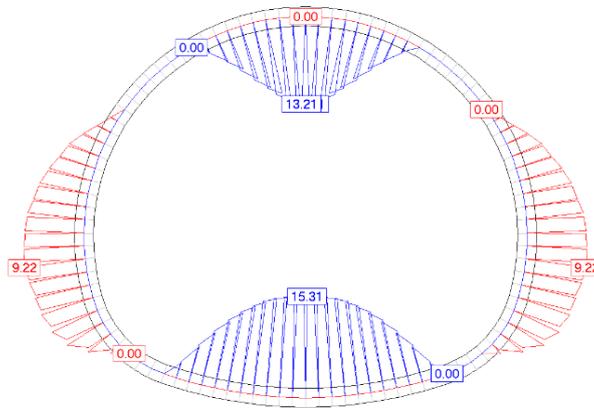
Secção TV.2. Armaduras de cálculo de flexão (cm<sup>2</sup>/m)
